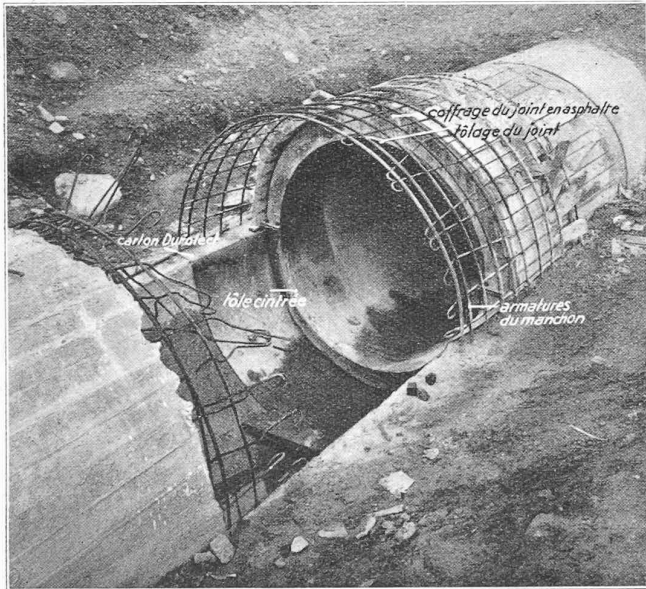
Coffrage et armature d'un joint de dilatation.
